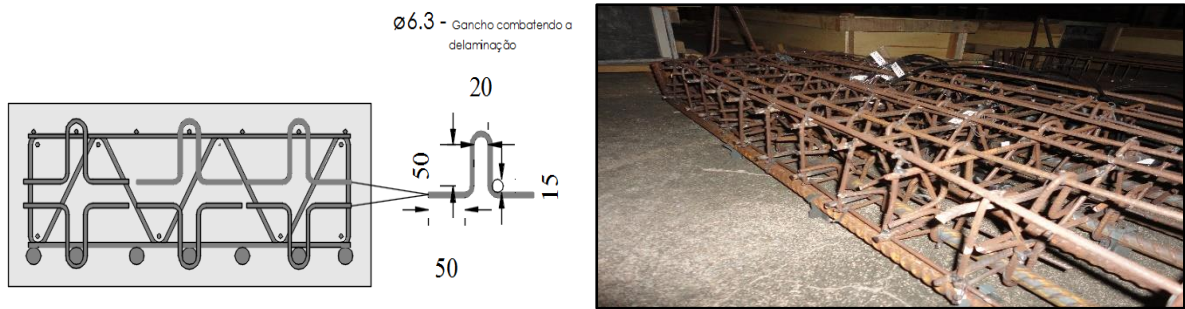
Estribo W com adição de ganchos de projeto e estribo W com adição de ganchos executados
